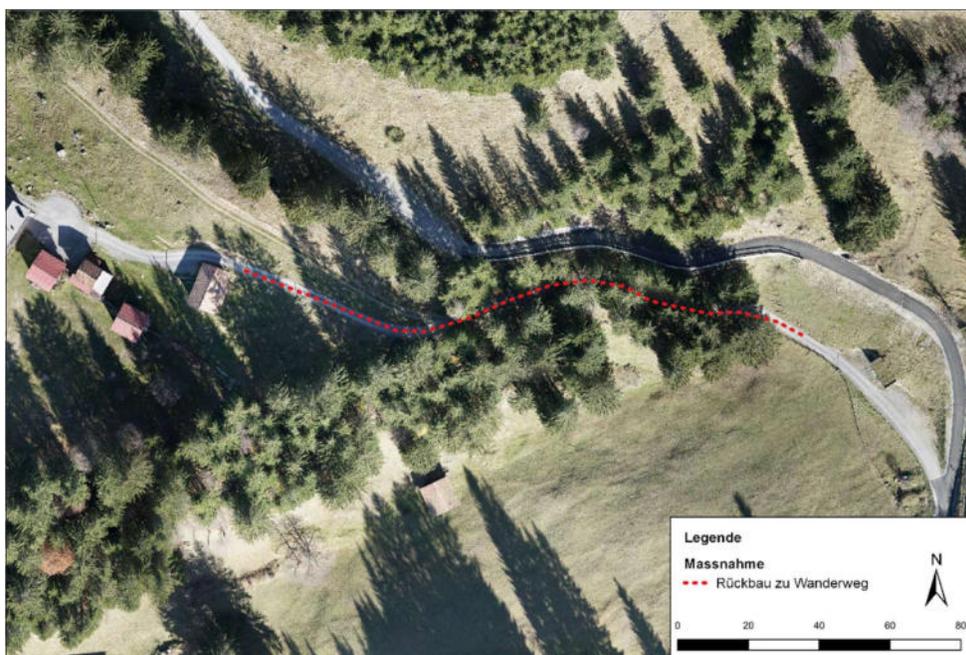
Rückbau bestehende Zufahrt zu Wanderweg
